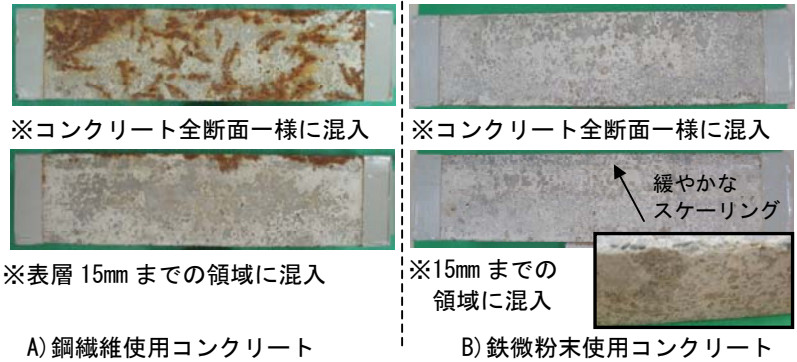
塩水乾湿試験 95 サイクル後のコンクリート側面の劣化状況
